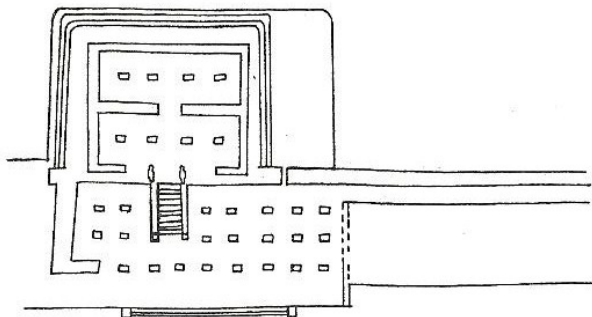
Vista superior de la Columnata del Noroeste junto con la Subestructura de los Guerreros
